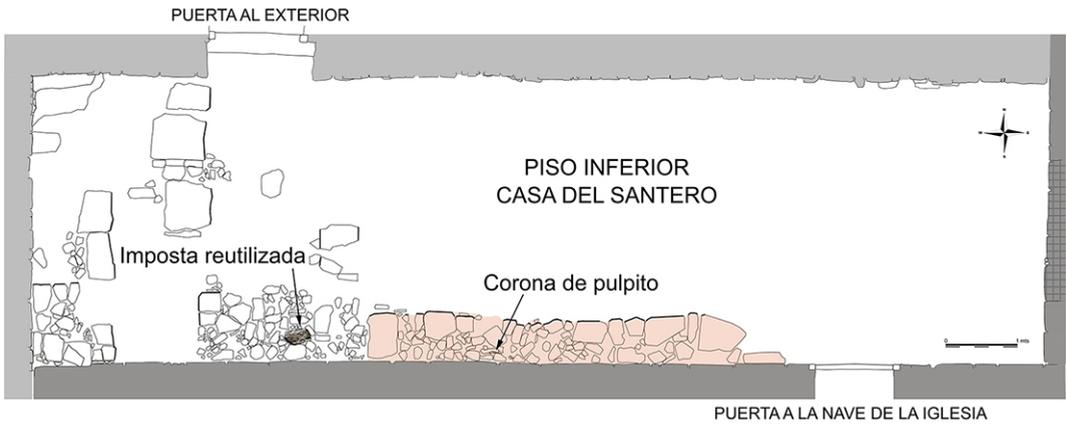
Planta de la Casa del Santero a la altura de suelo de su piso inferior, donde se muestran las estructuras descubiertas durante el seguimiento arqueológico.
